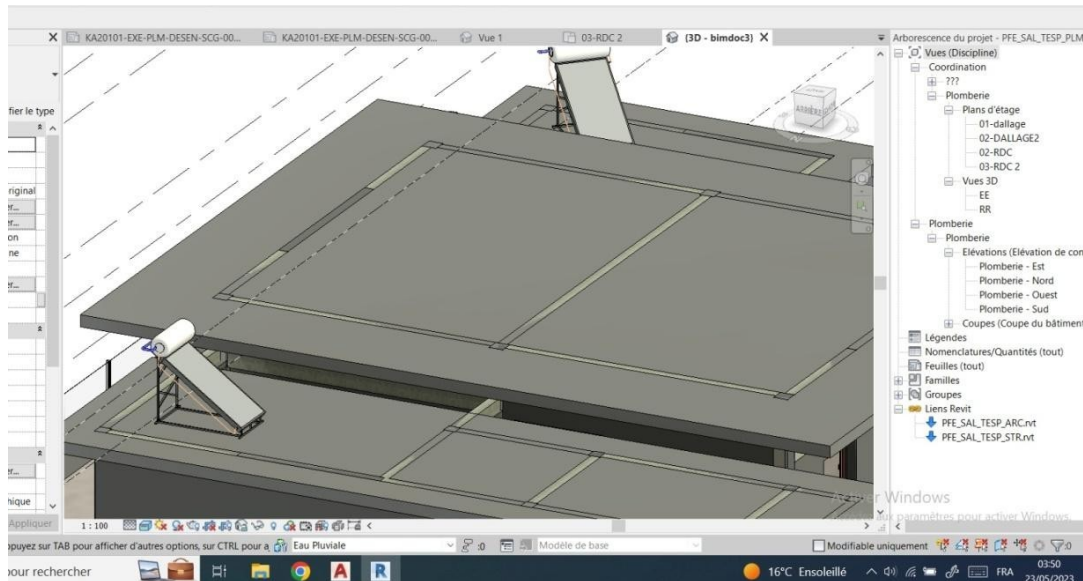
Mise en place des chauffe-eaux sur la terrasse
